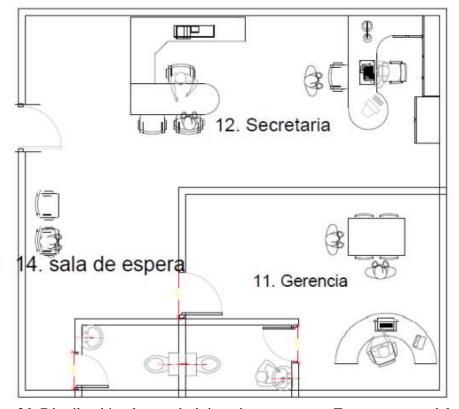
Distribución planta administrativa propuesta. Fuente autores del proyecto
